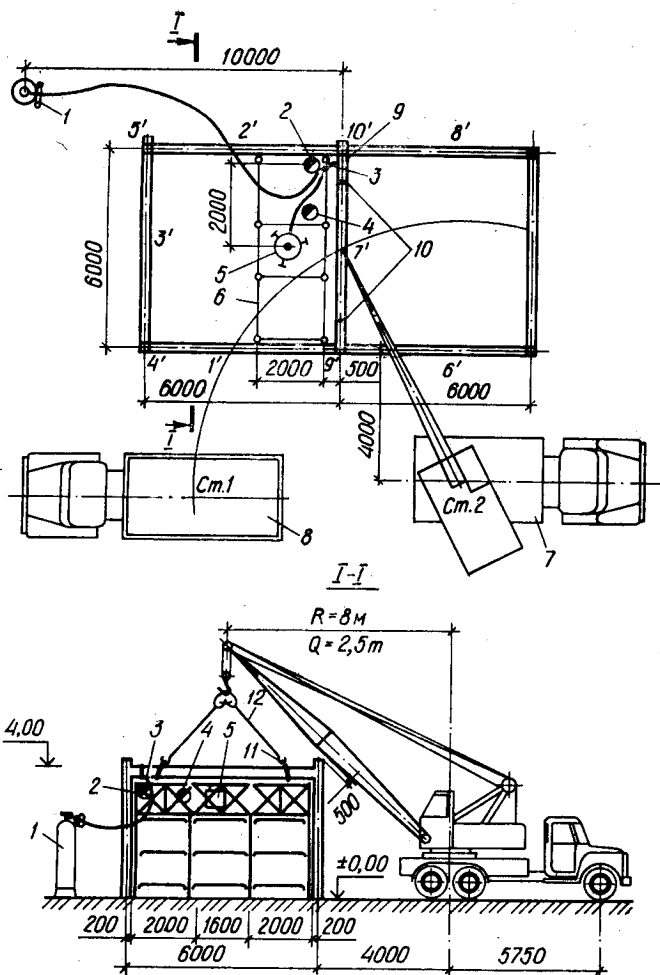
Схема разборки железобетонного каркаса реконструируемого здания при помощи установки УПКР-2:
